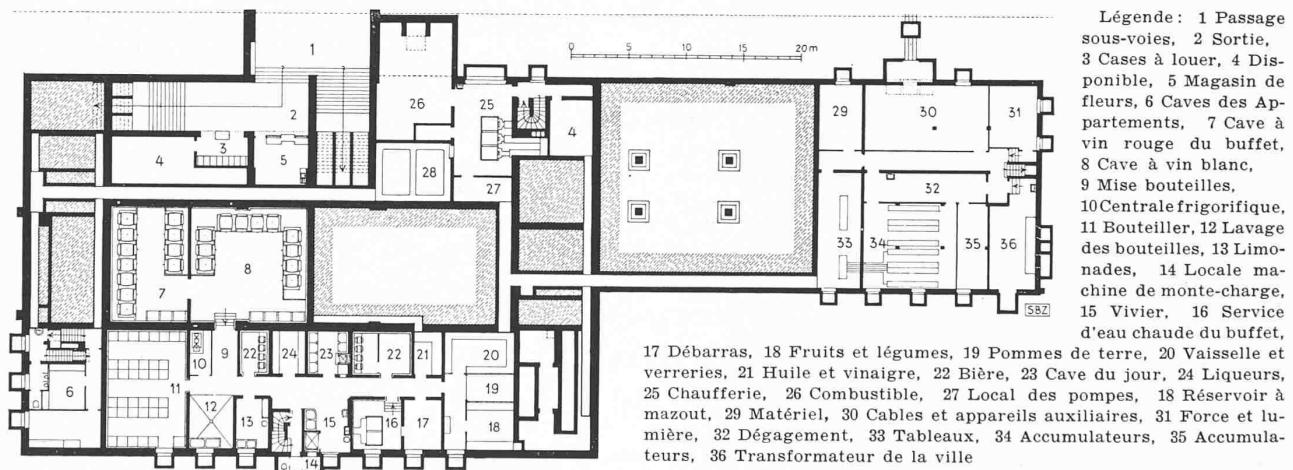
Plan de sous-sol. 1:600 (Légende à droite!)
